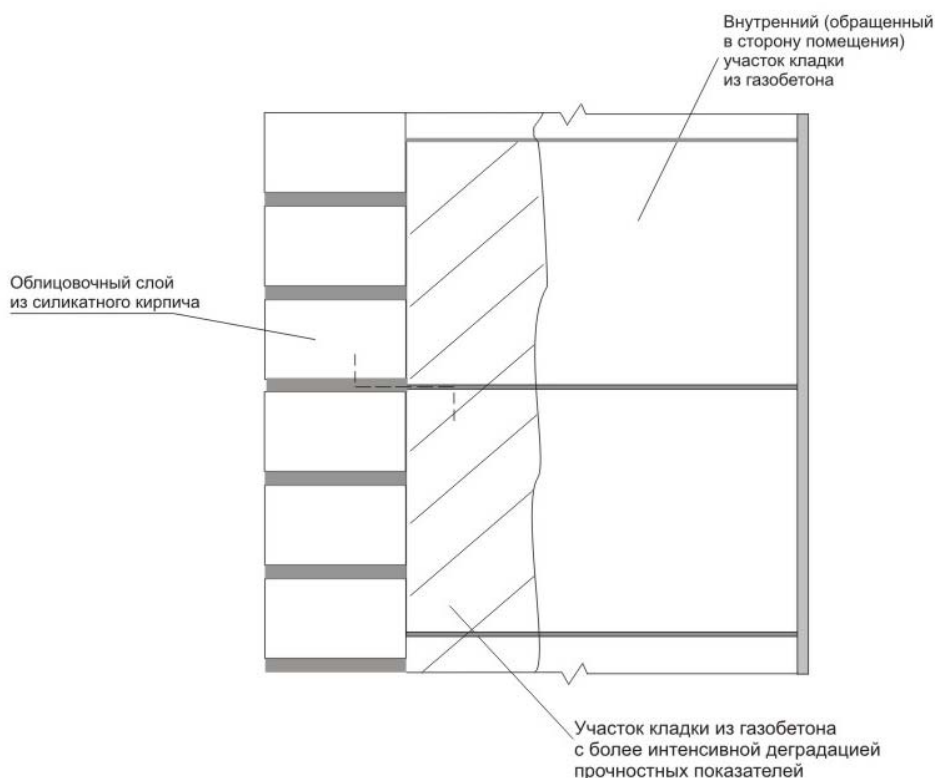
Схема разрушения испытываемой стеновой конструкции
